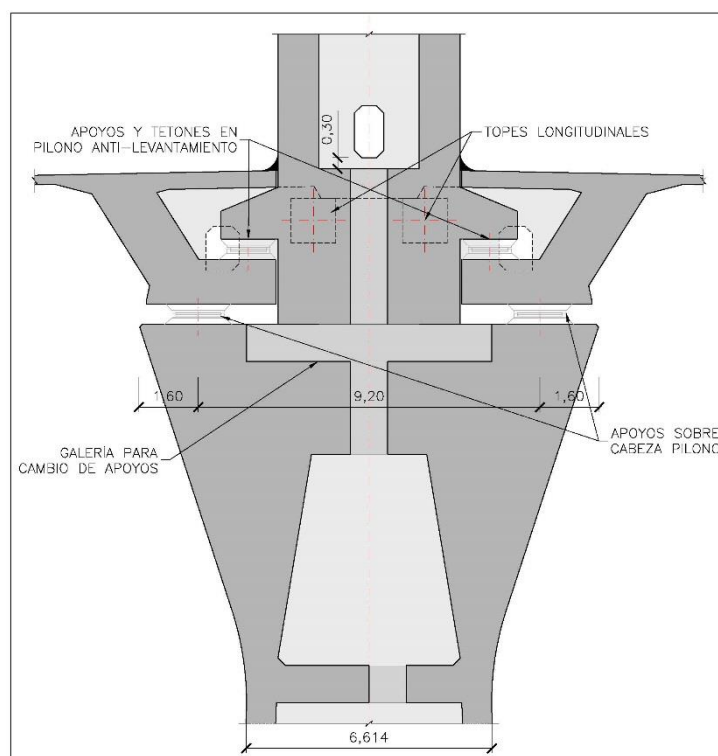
Sección transversal de la macla entre pilono y tablero por el eje del pilono
